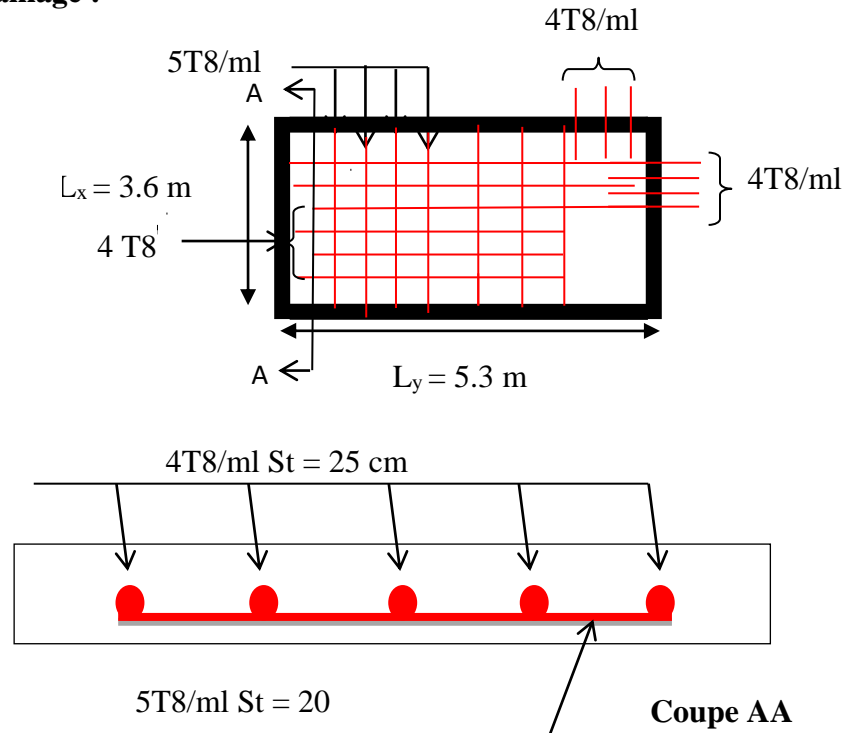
Ferrailage de la dalle pleine sur 04 appuis (D2).
